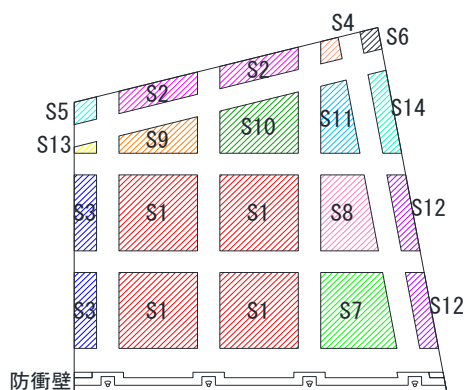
PCa 床版タイプ別平面配置図 (E スパン)
